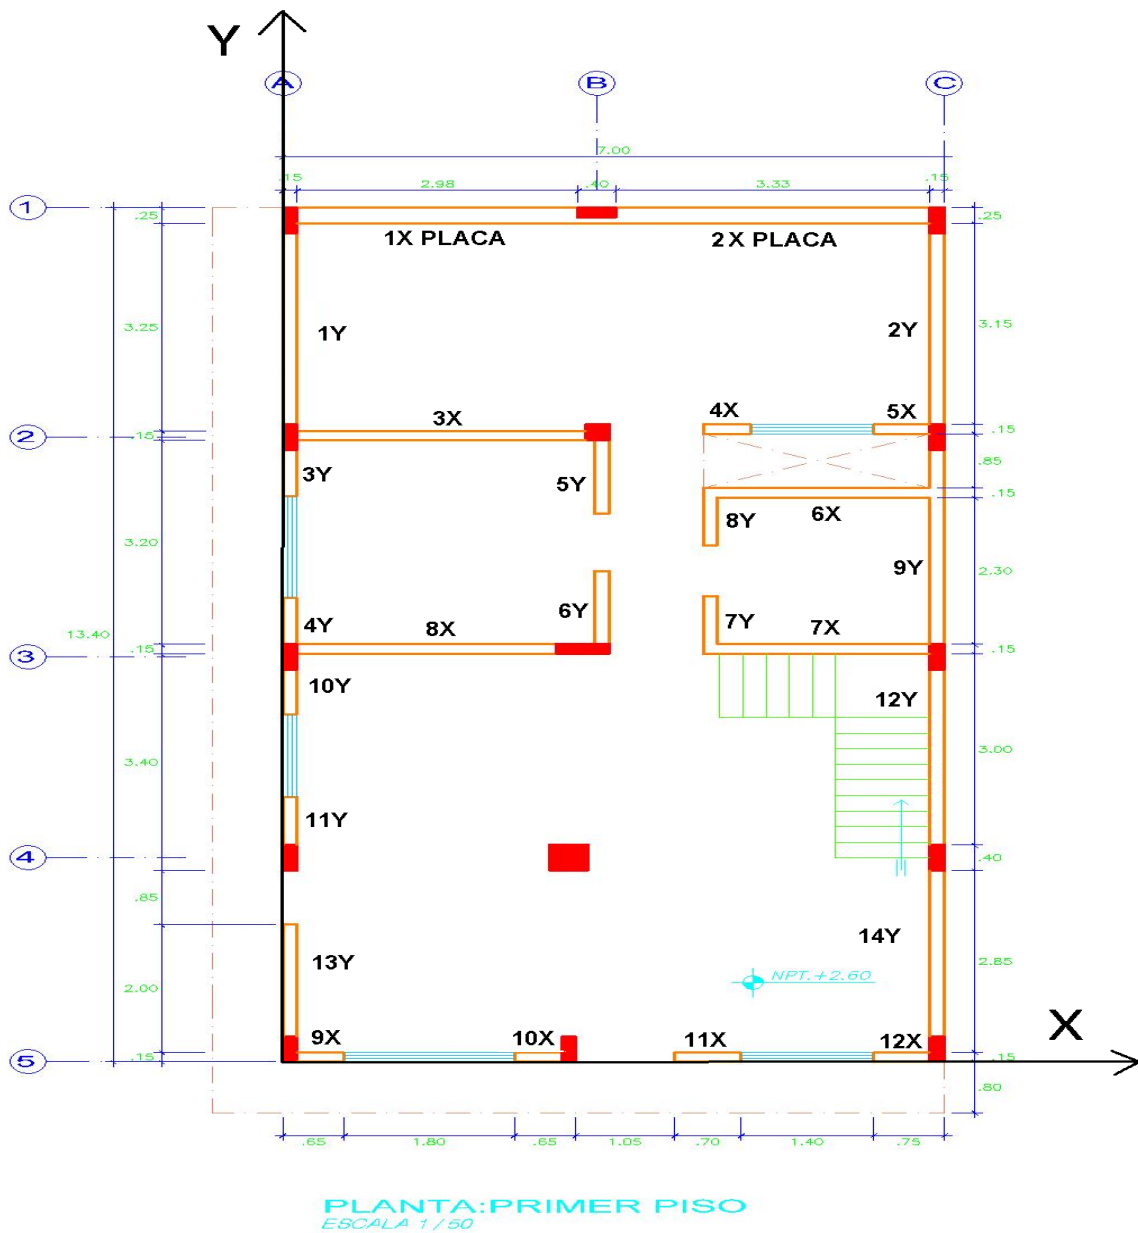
Enumeración de muros en vista en planta del primer piso - Lote 64 (Fuente: Elaboración propia)
